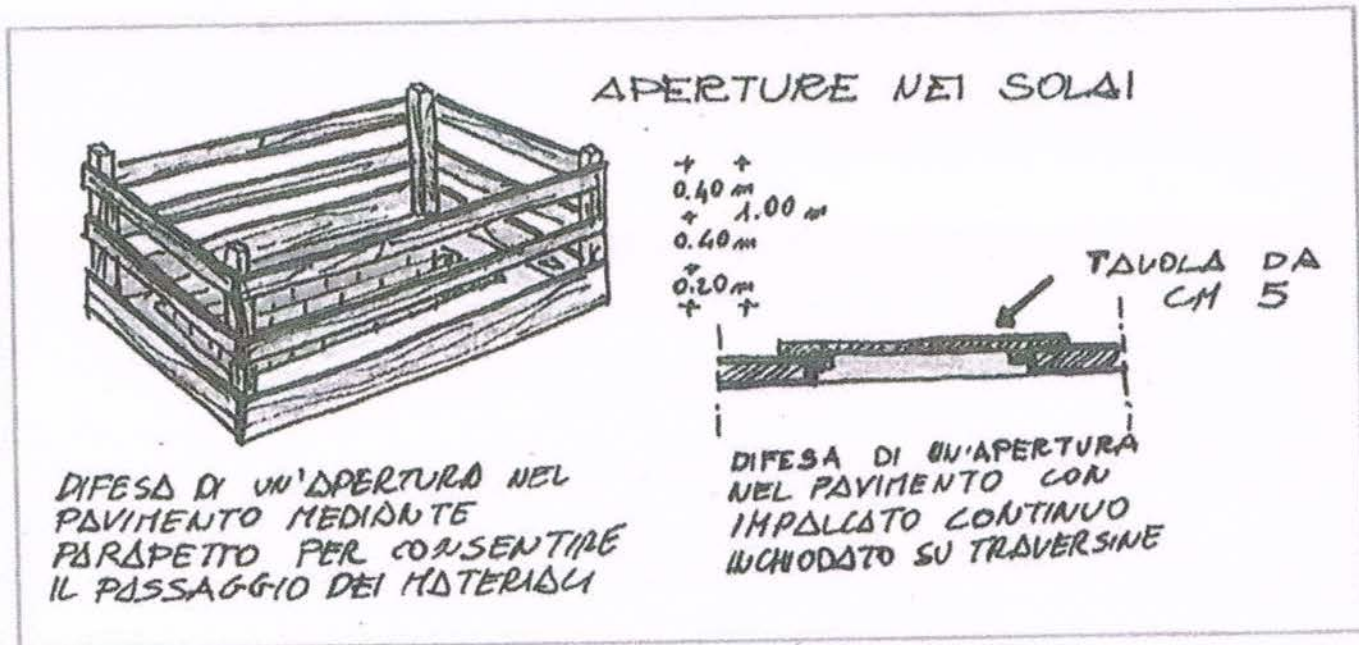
Protezione delle aperture nei solai durante il cantiere.
